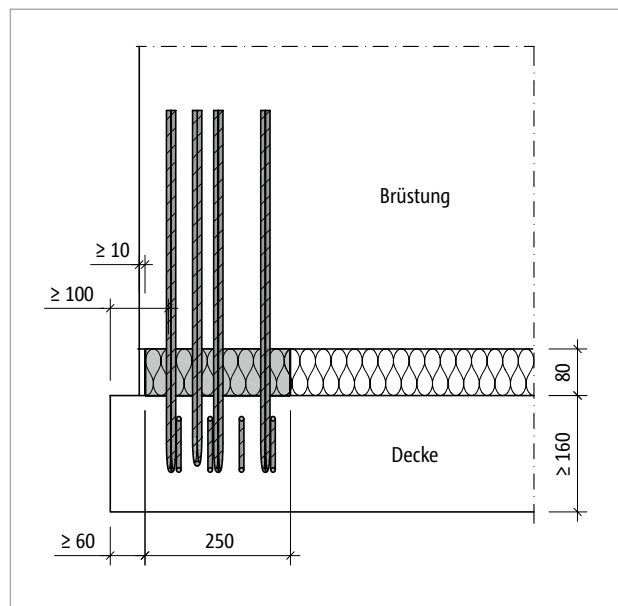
Schöck Isokorb® T Typ A: Ansicht Randabstände
